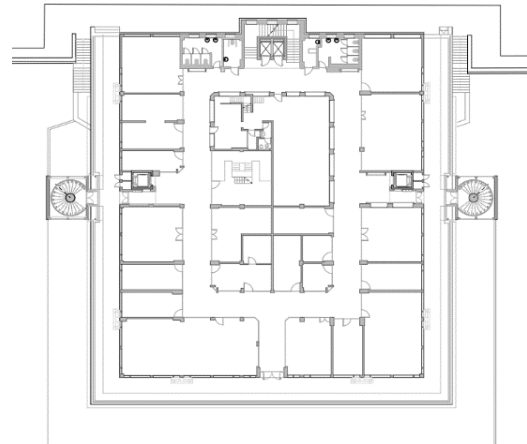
Planta 1º Piso, Centro comercial Girasolum.
